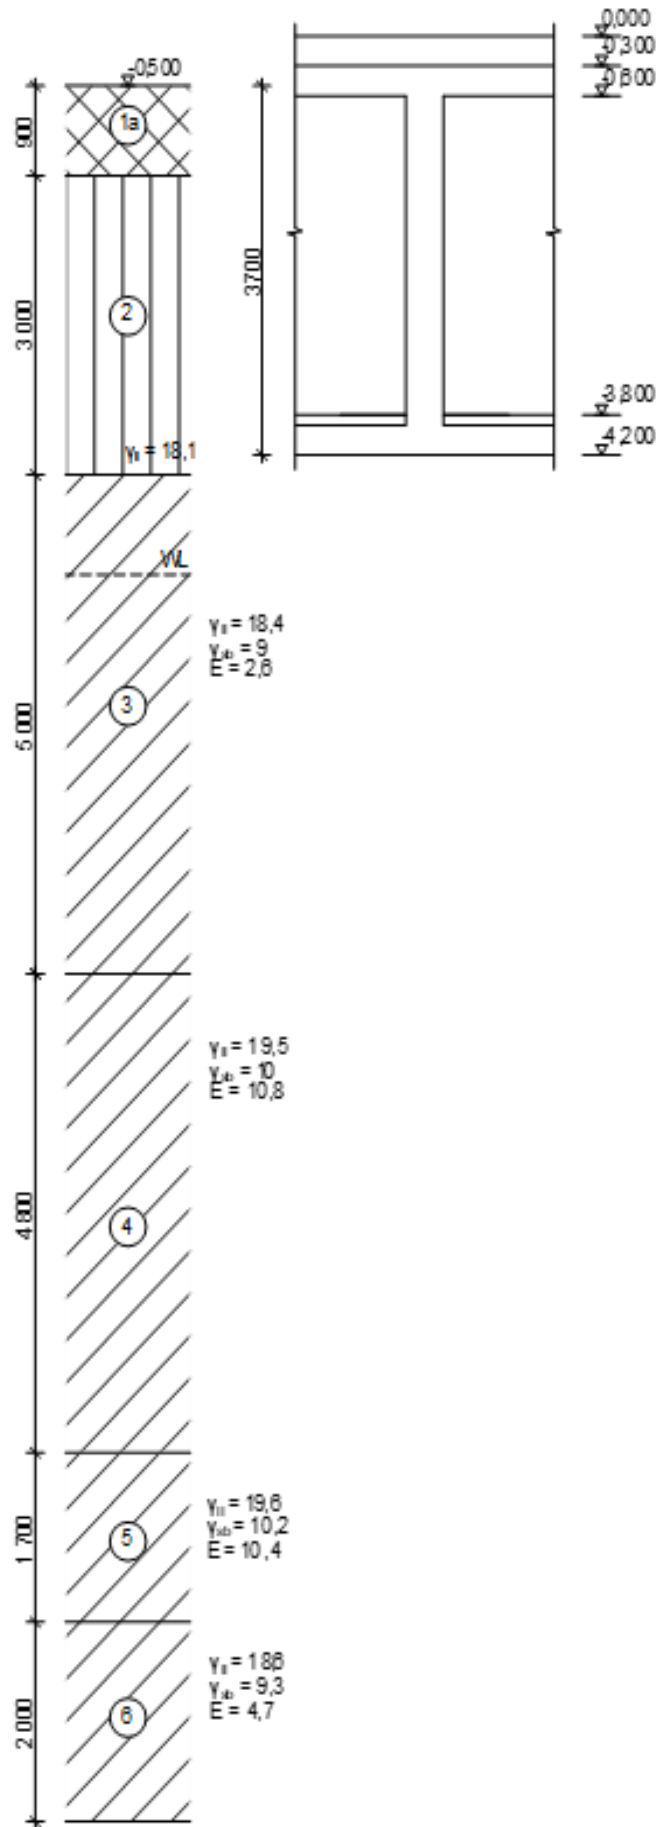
Положення фундаменту у варіанті фундаментної плити у ґрунті
